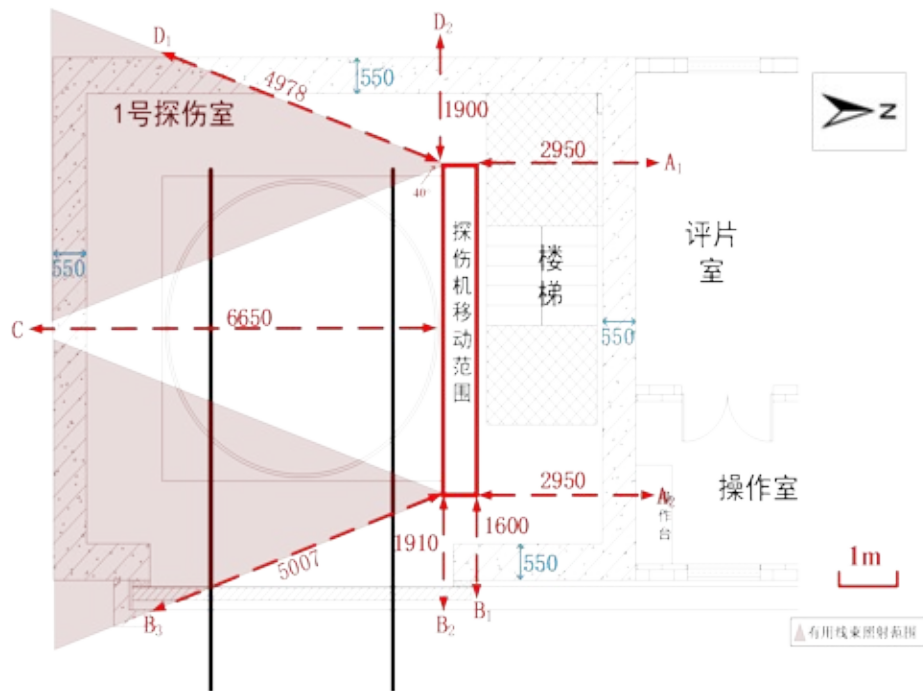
定向探伤机关注点位示意图（平面图，单位：mm）
